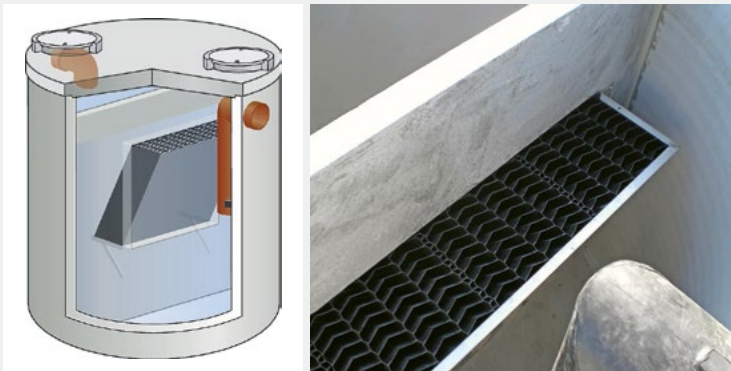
Lamellenklärer aus Betonfertigteilen. Mit Sammelraum für schwimmende Partikel und speziellen Einbauten, die Sedimentation und Flotation ermöglichen.
